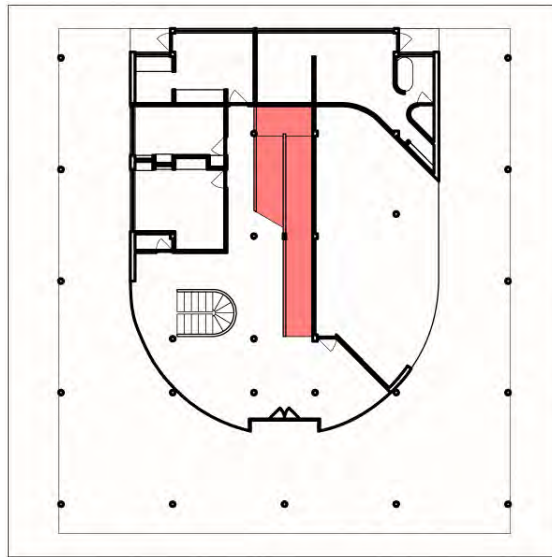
Villa Savoye, Localização da rampa (Ilustração nossa)
